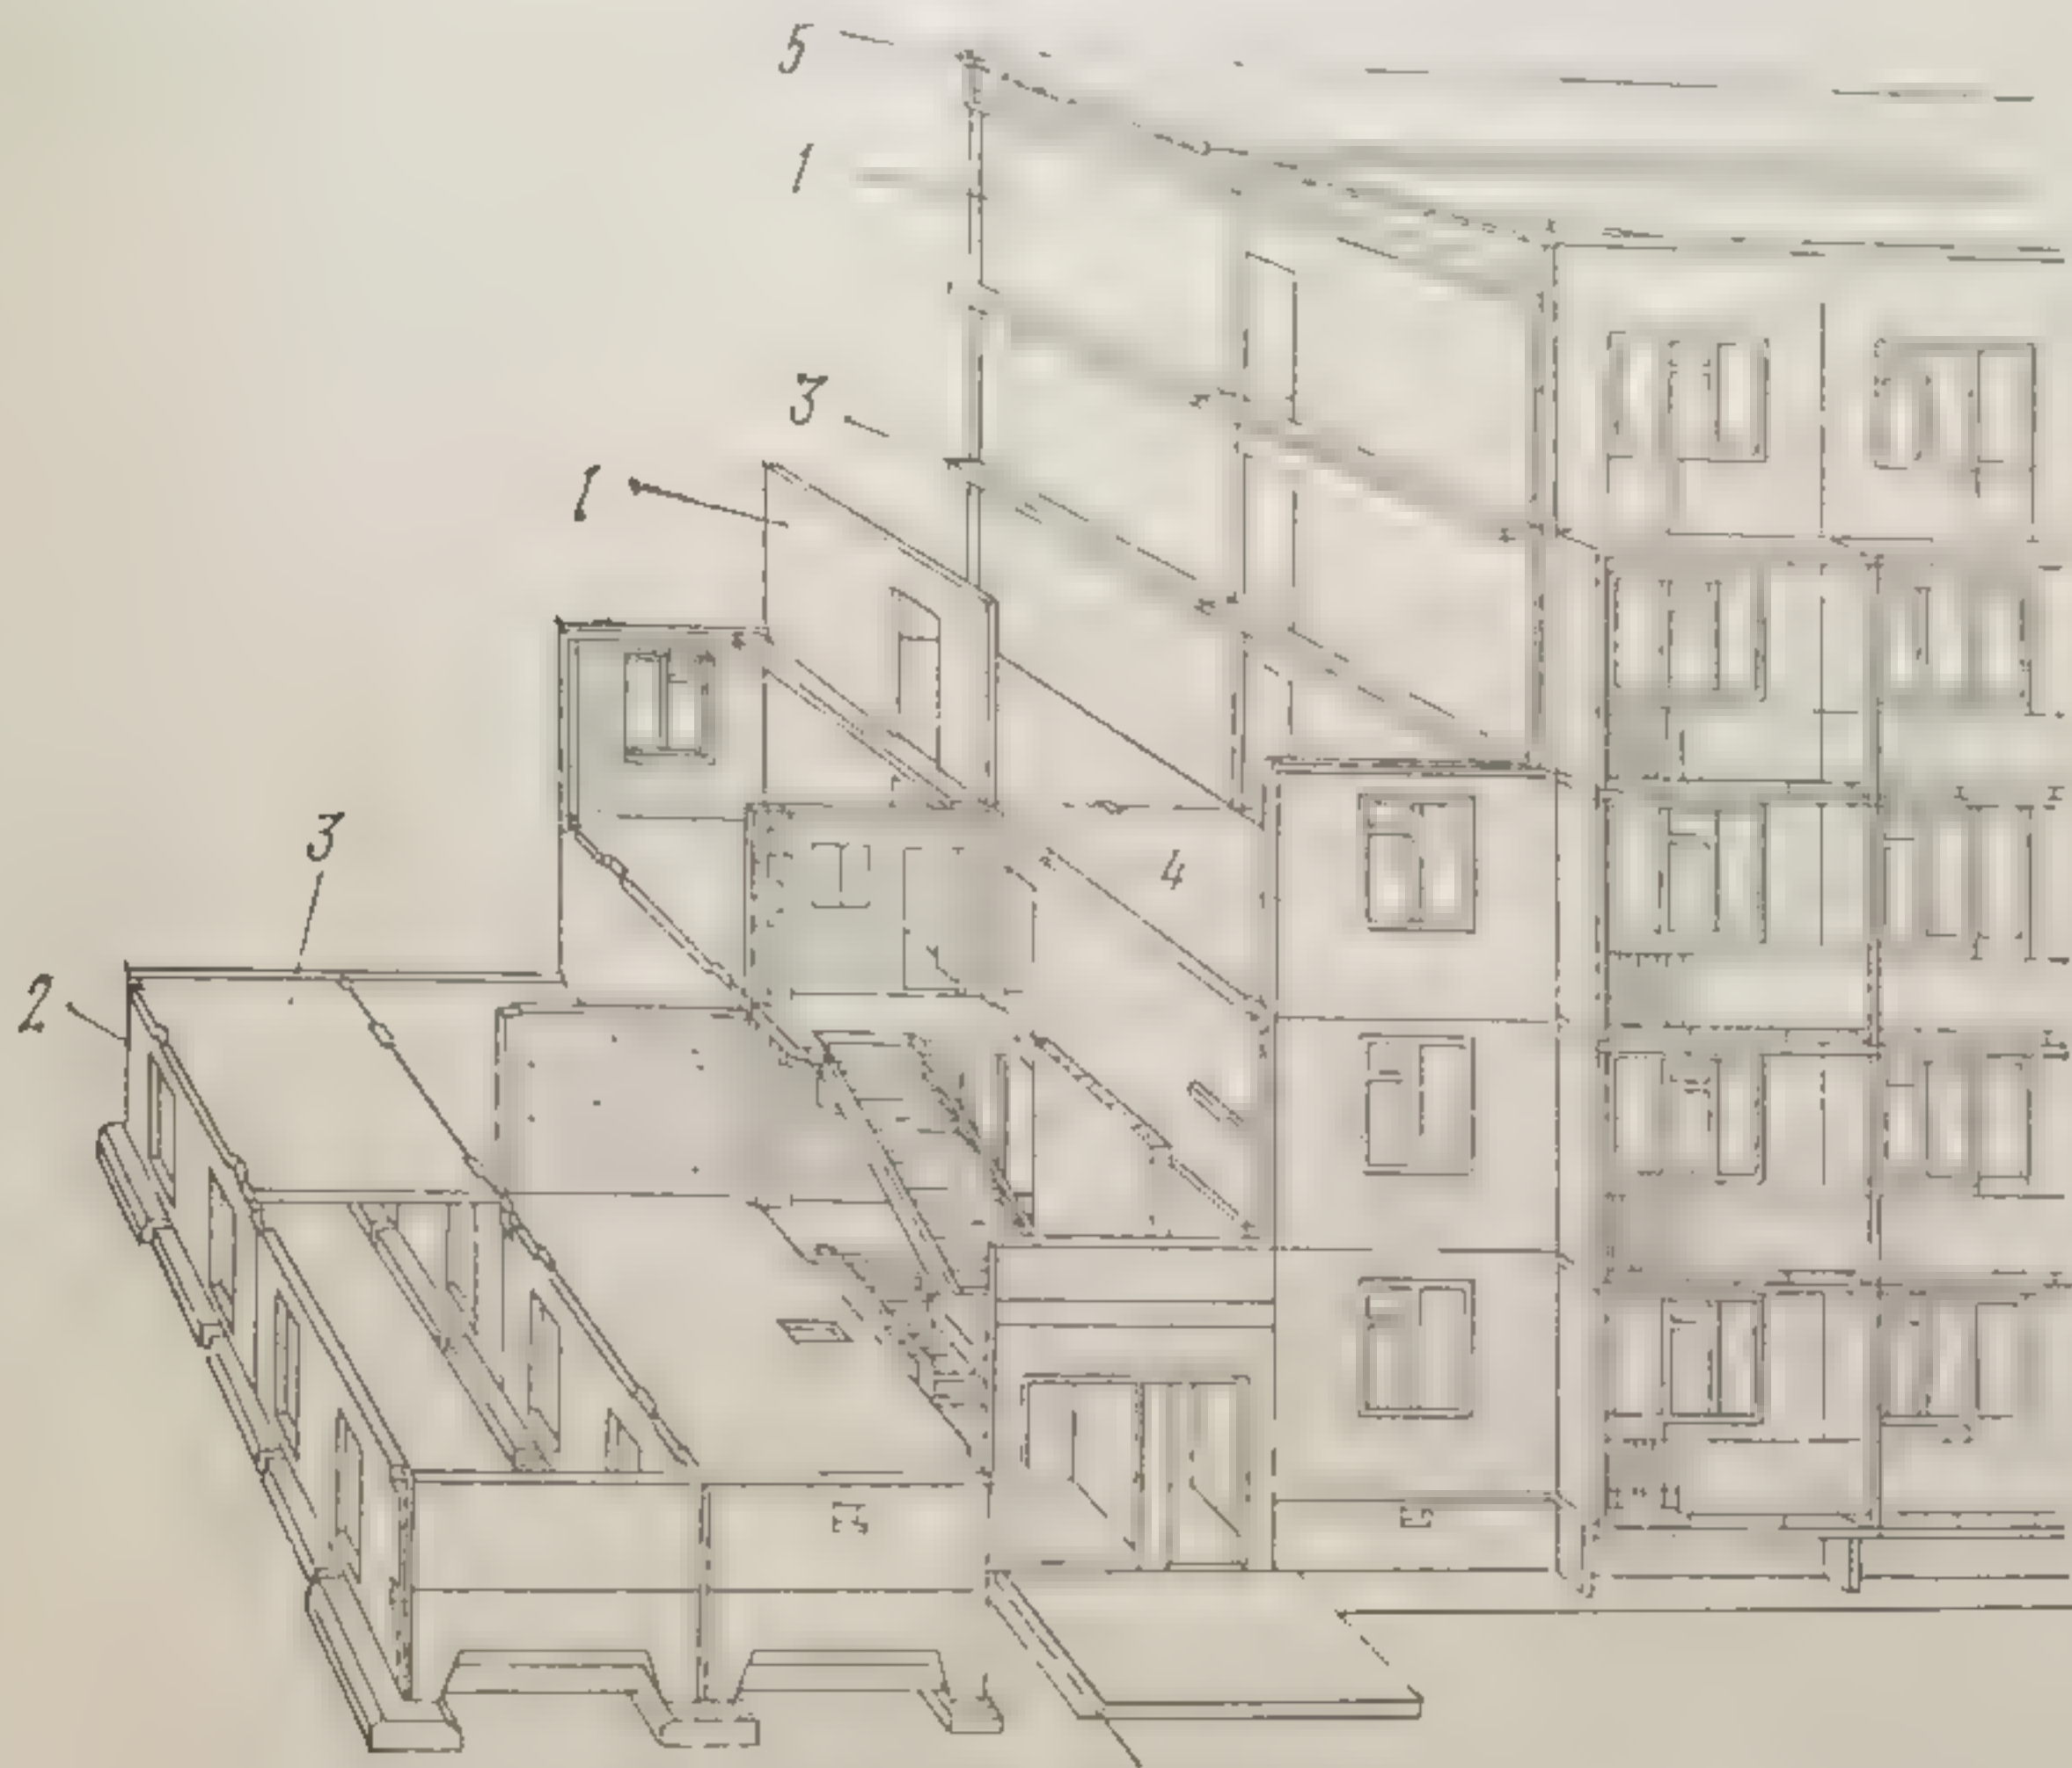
Конструкция многоэтажного крупнопанельного дома:
